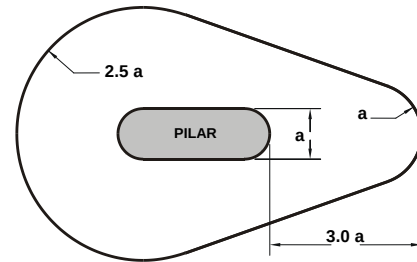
Esquema de la escollera en planta (espesor $a=1.5$ m)
